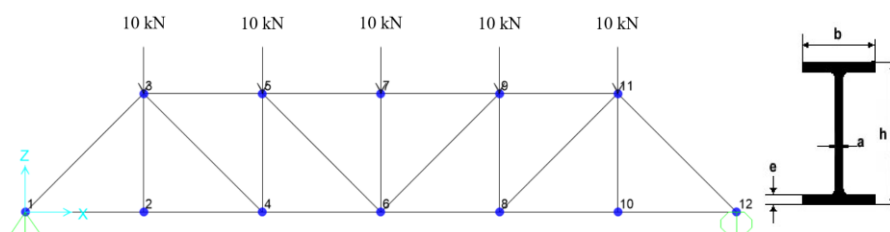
Modello nominale piano di trave reticolare in acciaio e della sezione trasversale delle aste.
